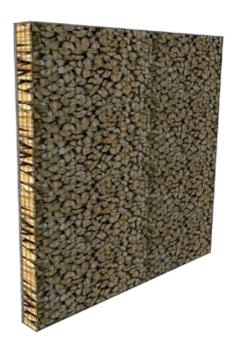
Muro gavión de retazos con madera FUENTE: Autoría propia.
